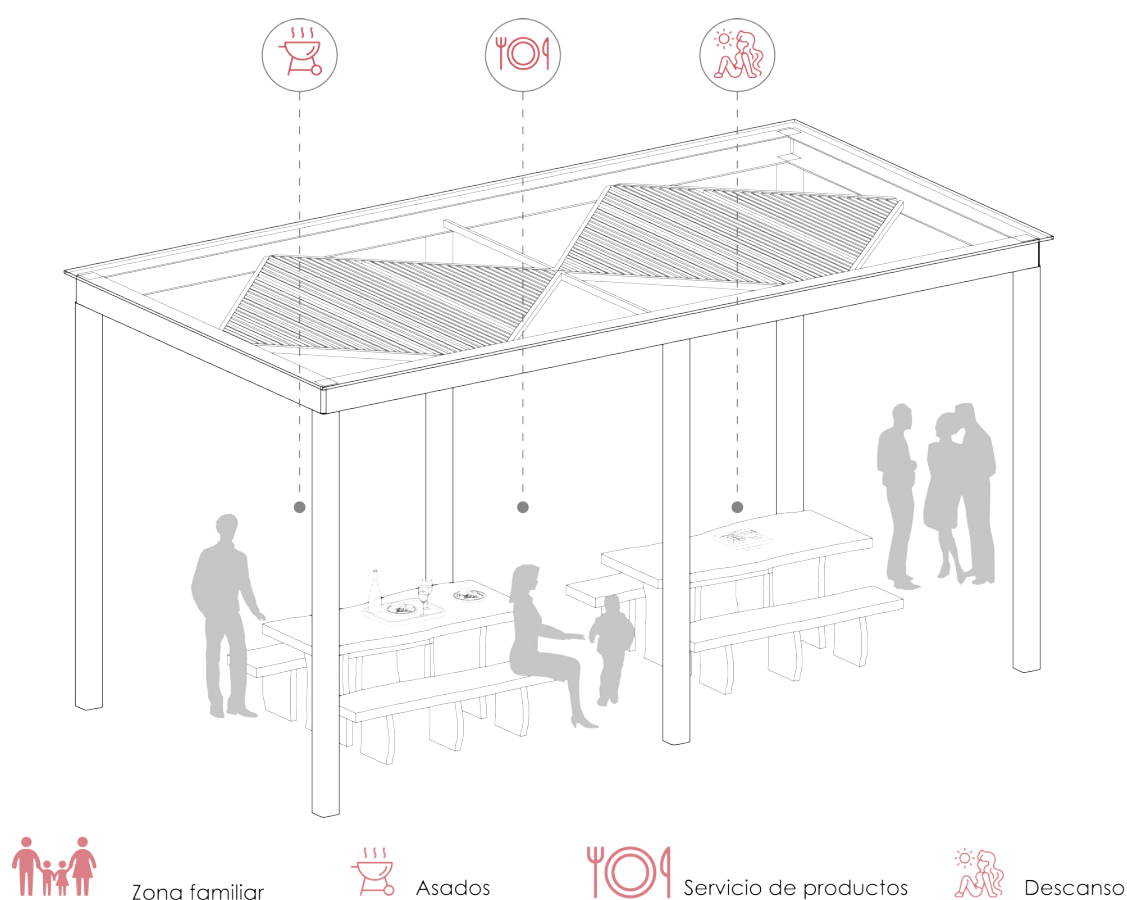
Axonometría – Zona familiar. Fuente y Elaboración: Autora.
